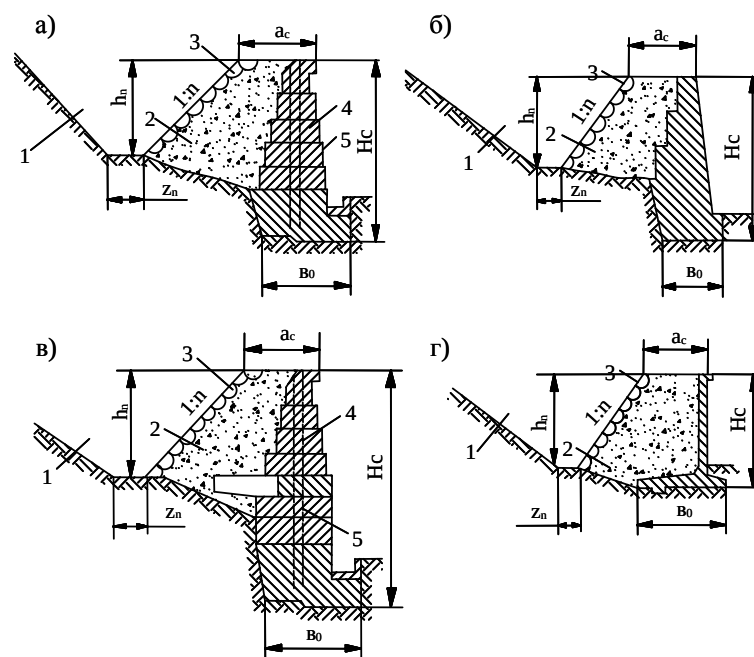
Конструкции противообвальных улавливающих стен (массивные и сборные): *а*—массивная стена из бетонных блоков; *б*—массивная стена из бутобетона; *в*—массивная стена из бетонных блоков с разгружающей площадкой; *г*—стена из сборного железобетона углового профиля; 1—улавливающая пазуха; 2—амортизирующая отсыпка; 3—выкладка откоса крупным камнем; 4—бетонные блоки; 5—арматура
